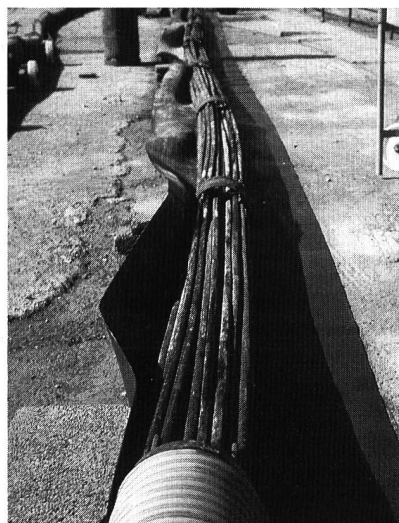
Détail d'un tirant. Au premier plan le début de la zone d'ancrage avec sa gaine métallique. Au second plan, mise en place et collage de la gaine PVC sur la longueur libre.
